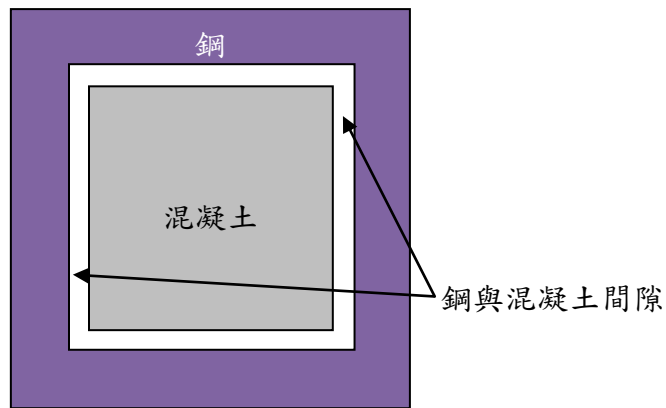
內灌混凝土箱型鋼柱試體斷面圖
